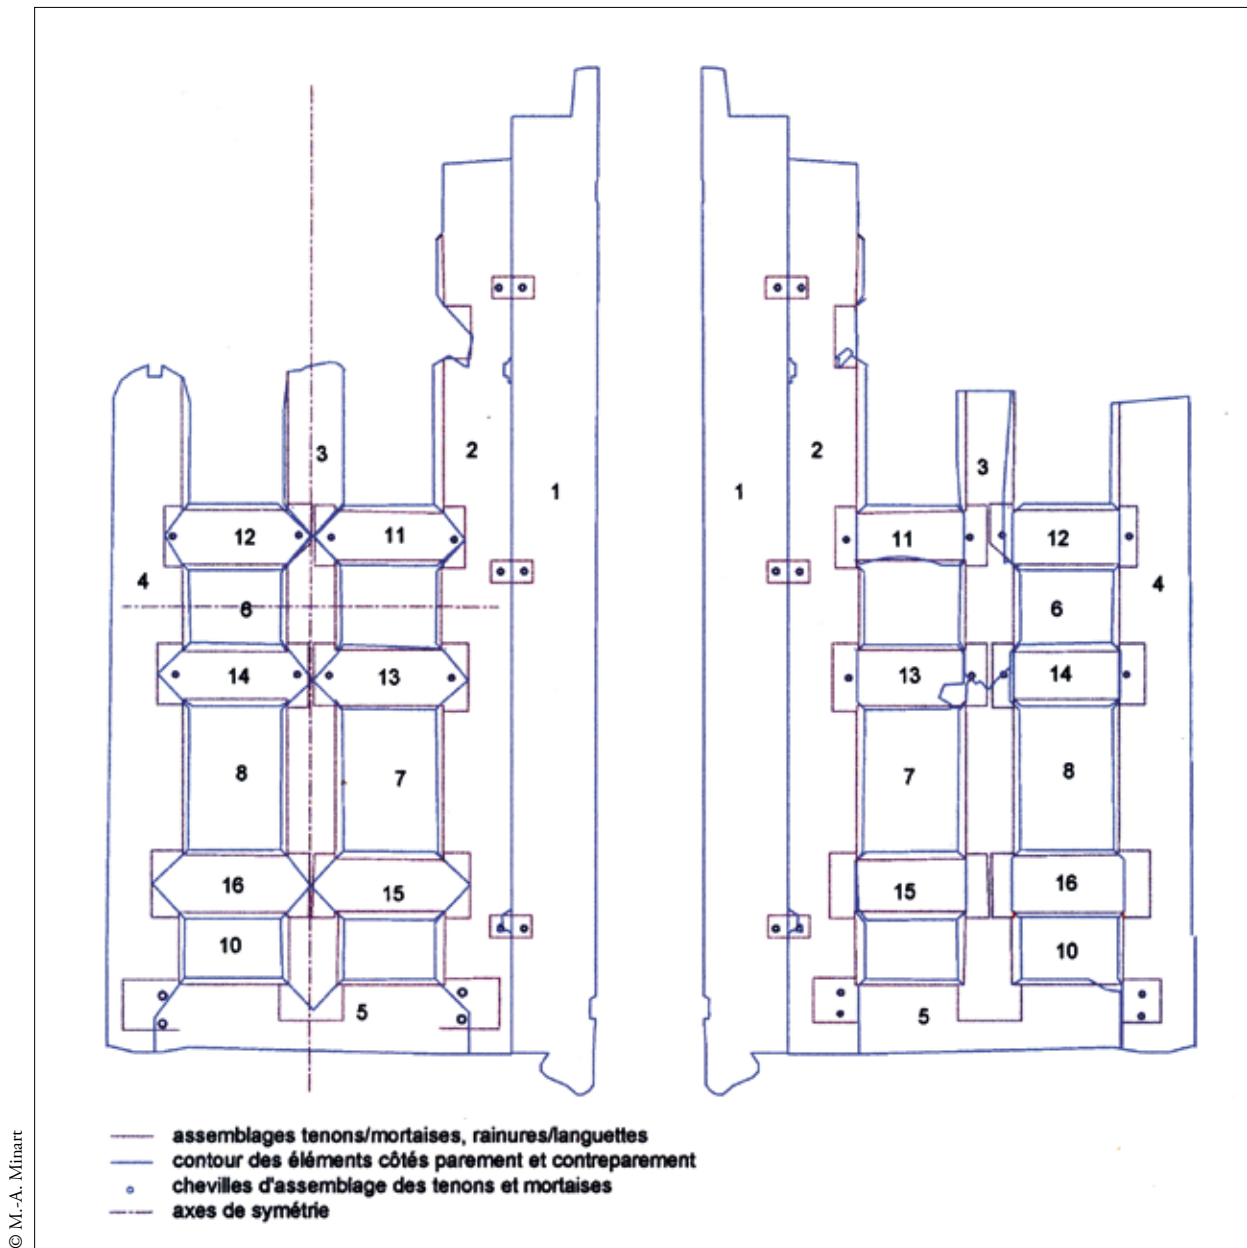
Schémas des assemblages à tenons et mortaises en parement et contreparement.
